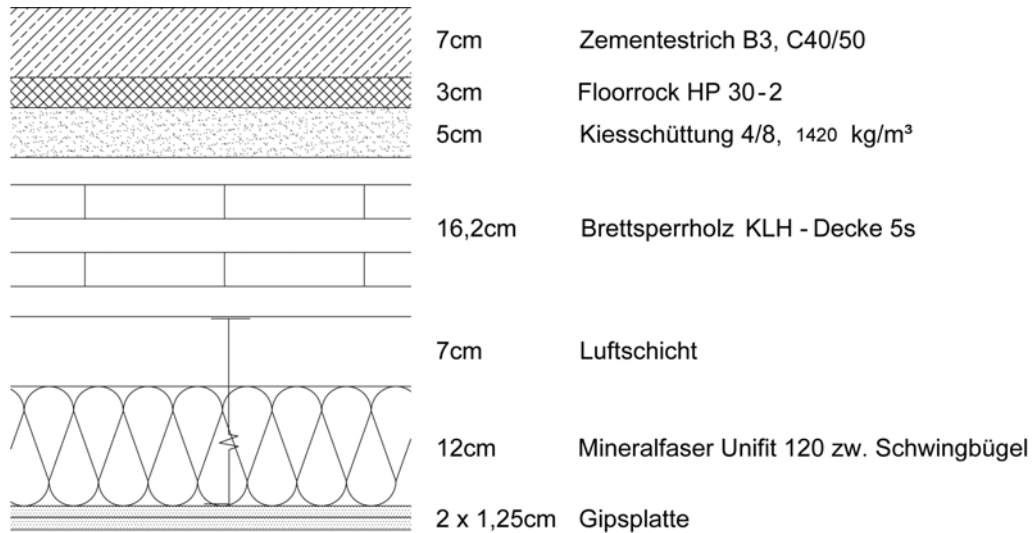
gemessener Fußbodenaufbau – Rohdecke KLH Brettsperrholz 5s
